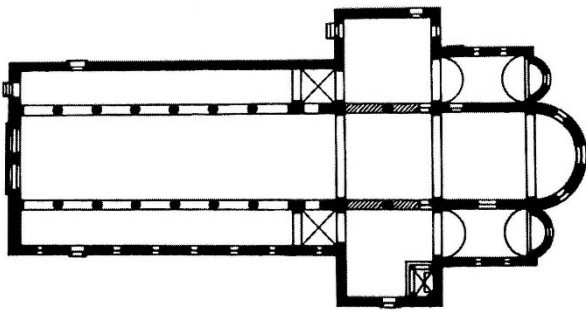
Grundriss der Stiftskirche Hamersleben
